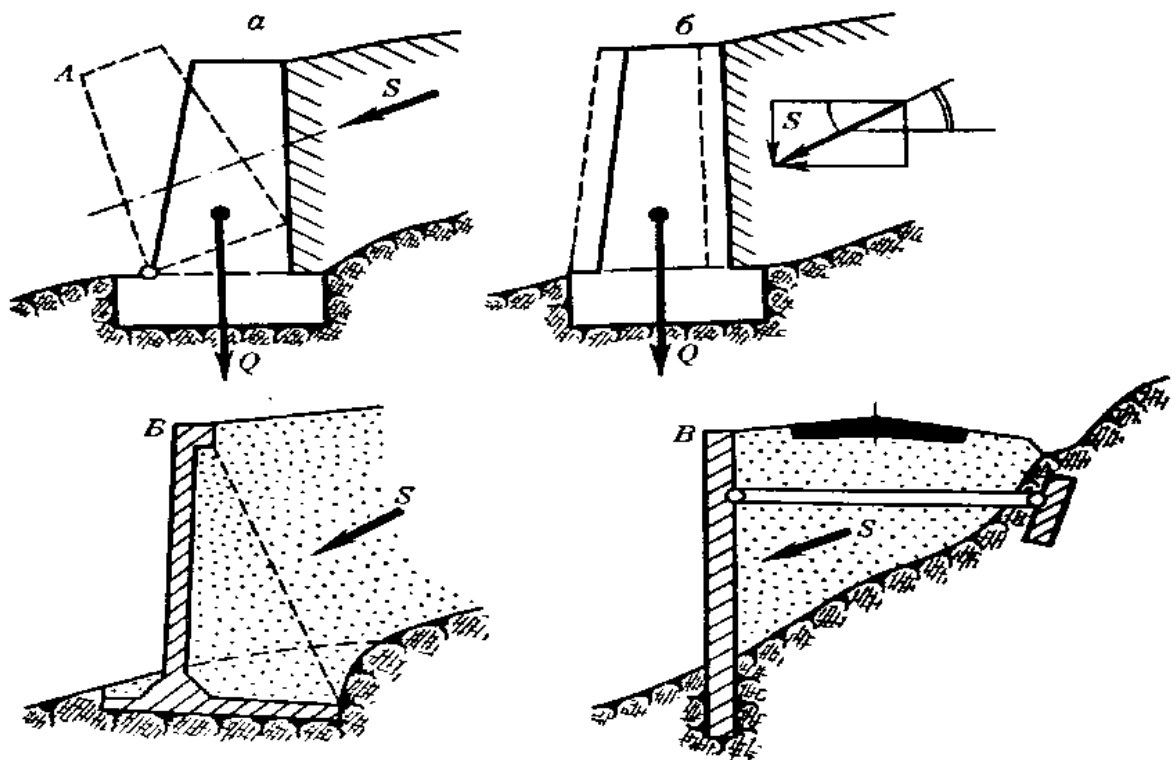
Схеми підпірних стінок [1]: *A* – гравітаційні (*a* – перекидна; *б* – зрушена); *B* – легка залізобетонна з навантаженою плитою на фундаменті; *B* – анкерна; *Q* – вага стінки; *S* – тиск ґрунту на стінку
